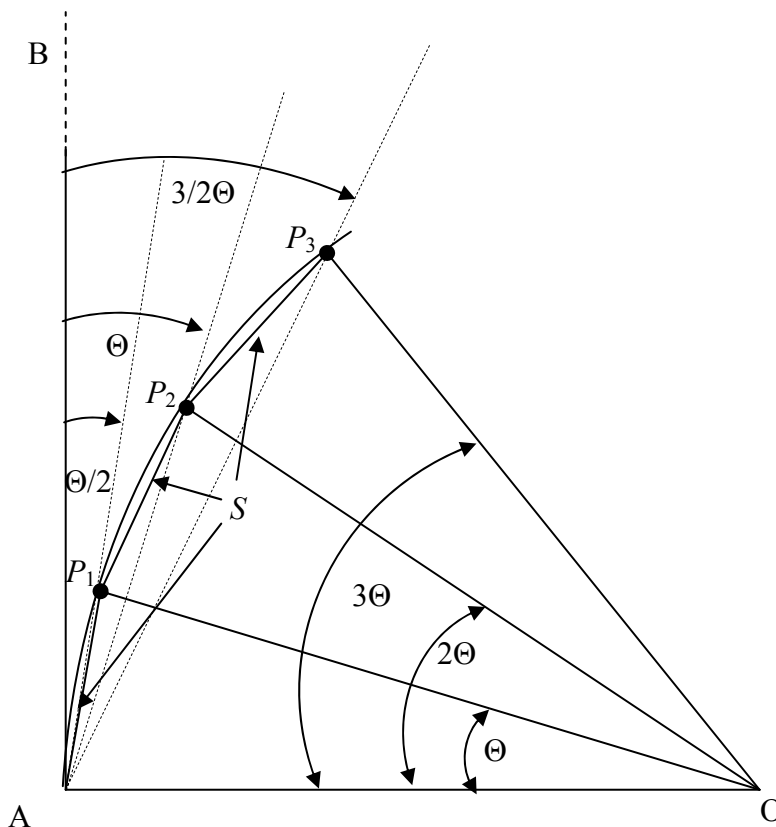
Схема детальной разбивки кривой способом полярных координат
